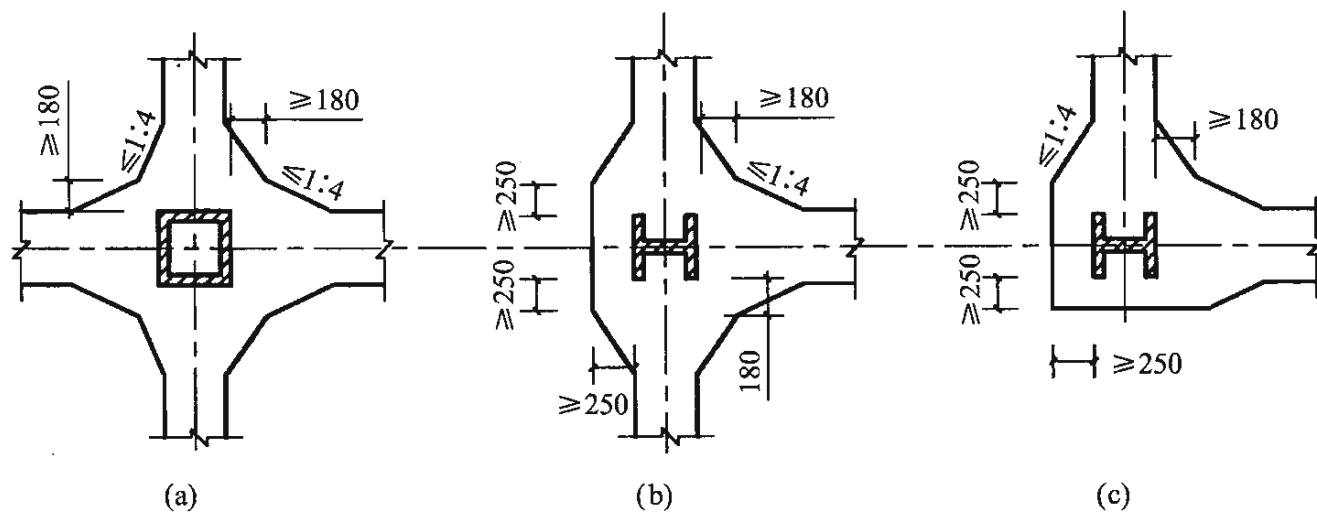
柱脚型钢的混凝土最小保护层
